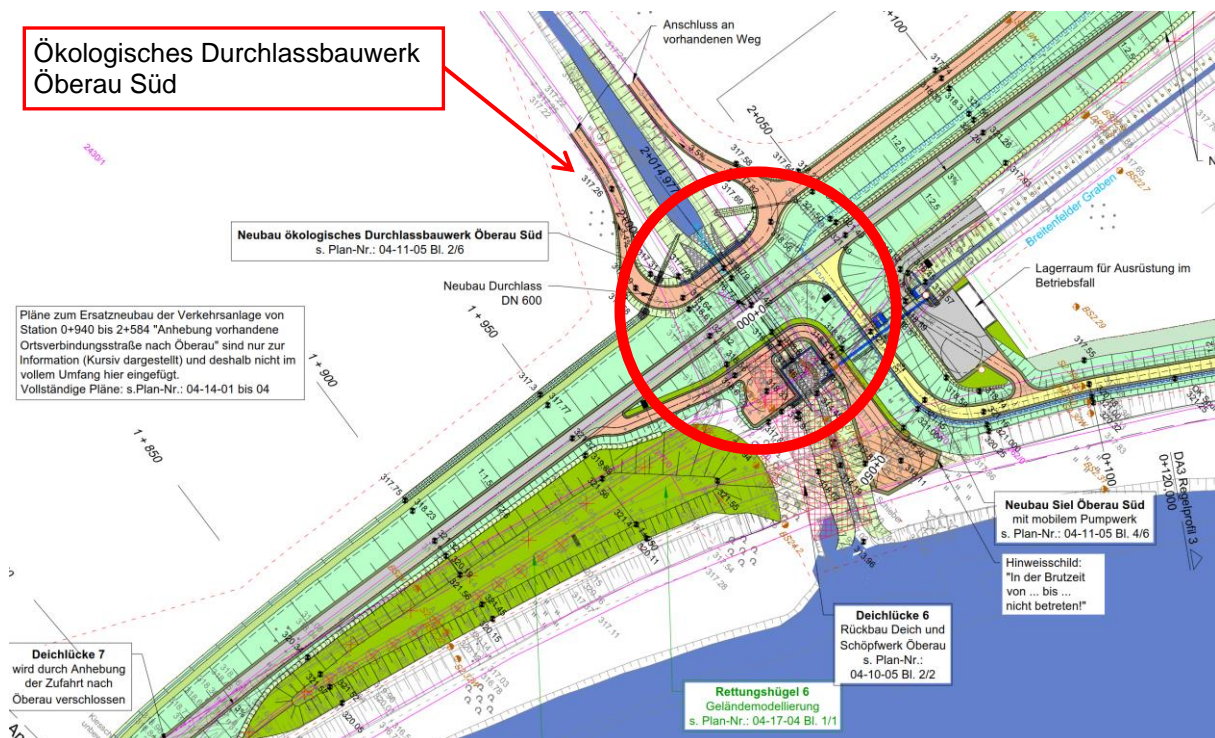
Ökologisches Durchlassbauwerk Öberau Süd, Lageplan (aus Plan 03-03-03, Blatt 2/3)
